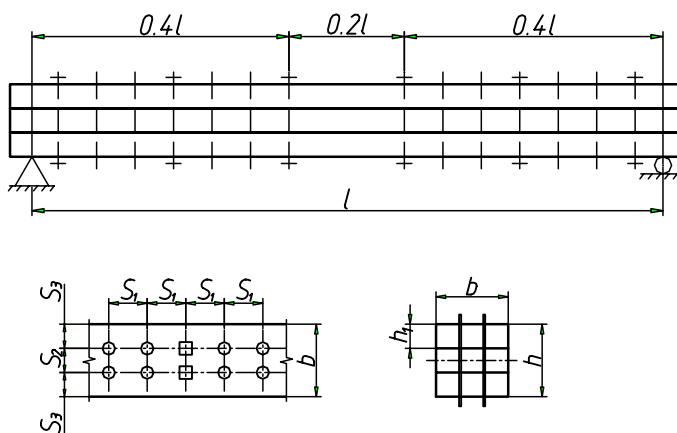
Конструкция составной балки на стальных цилиндрических нагельми
